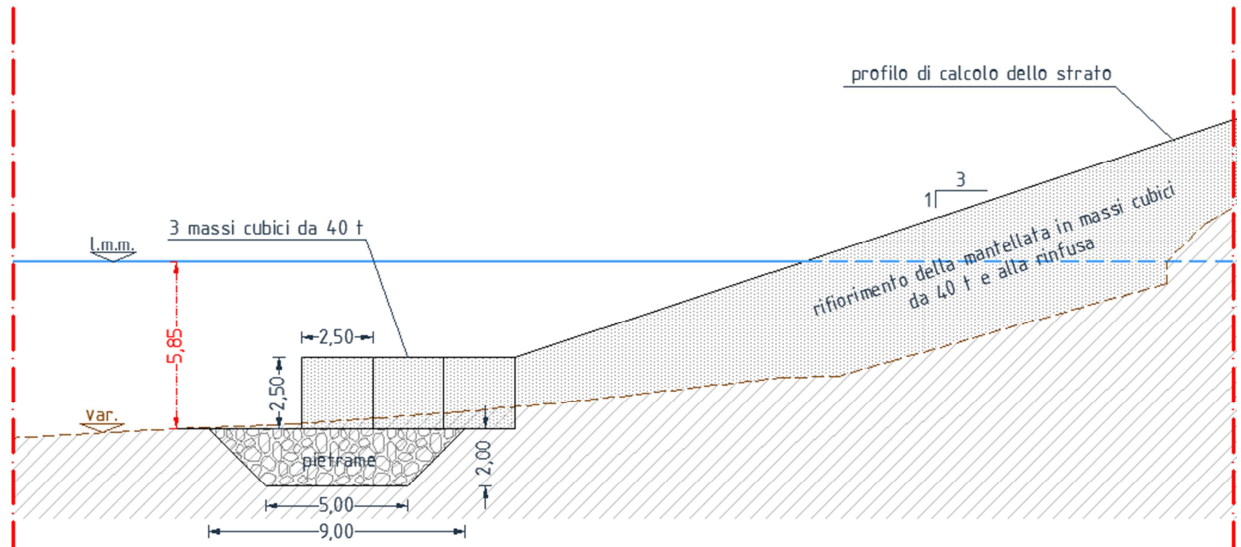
Sezione intervento di rifiorimento, piede della mantellata
